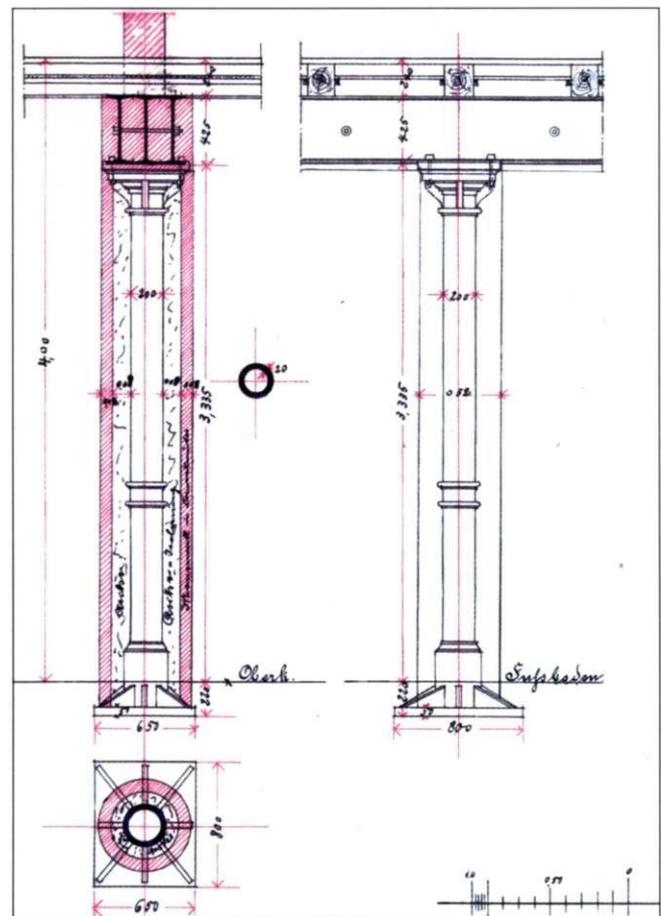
Konstruktionszeichnung einer in Pfeilermauerwerk eingebetteten, gußeisernen Säule, Liebknechtstraße 30
